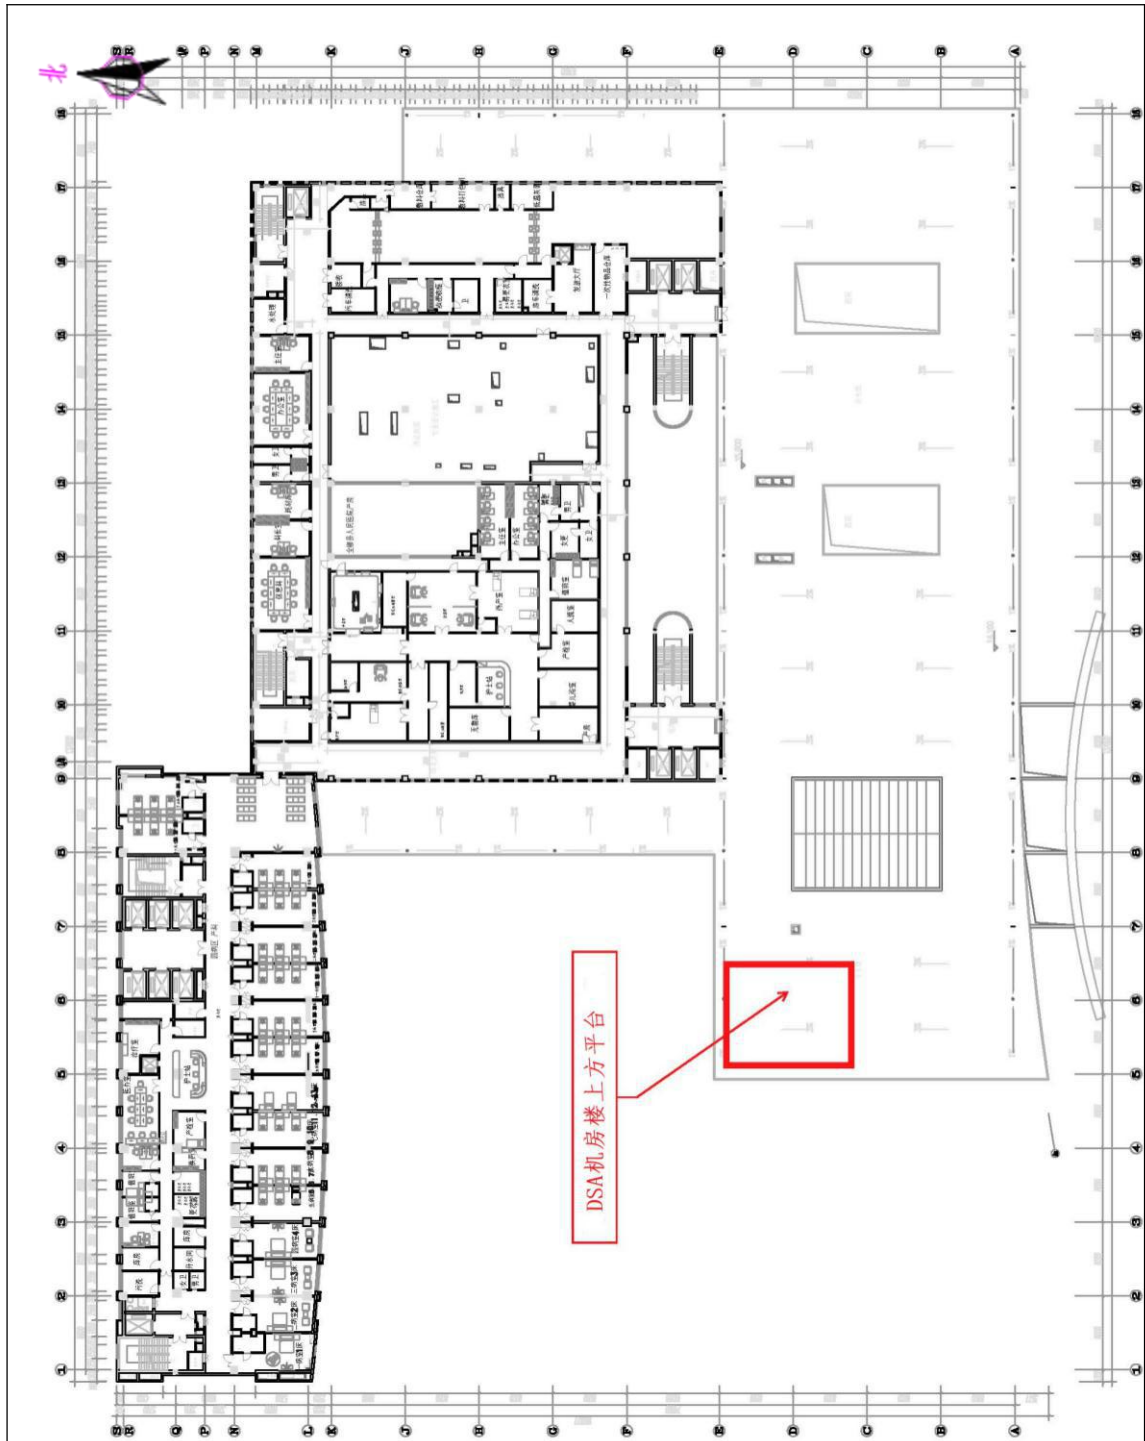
全椒县人民医院门诊楼四楼平台（DSA 机房上方）平面布置图
